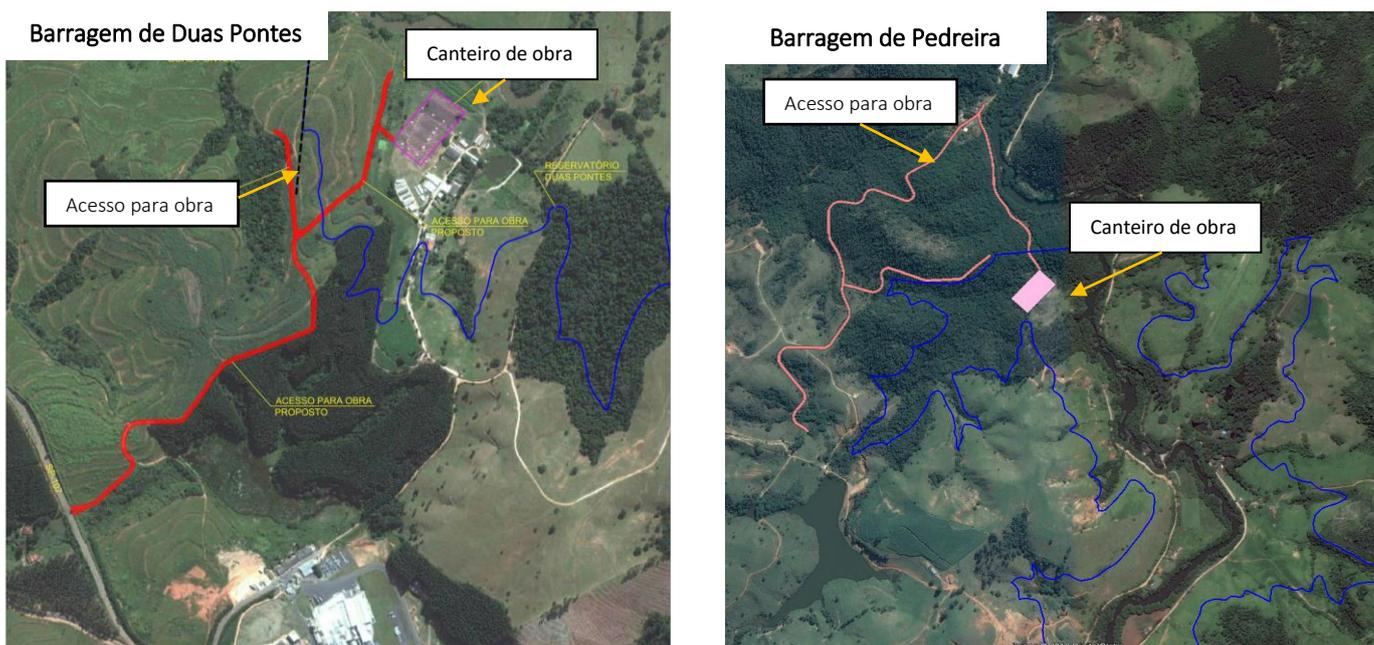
Canteiros de Obra e Acessos para construção das Barragens de Pedreira e Duas Pontes
